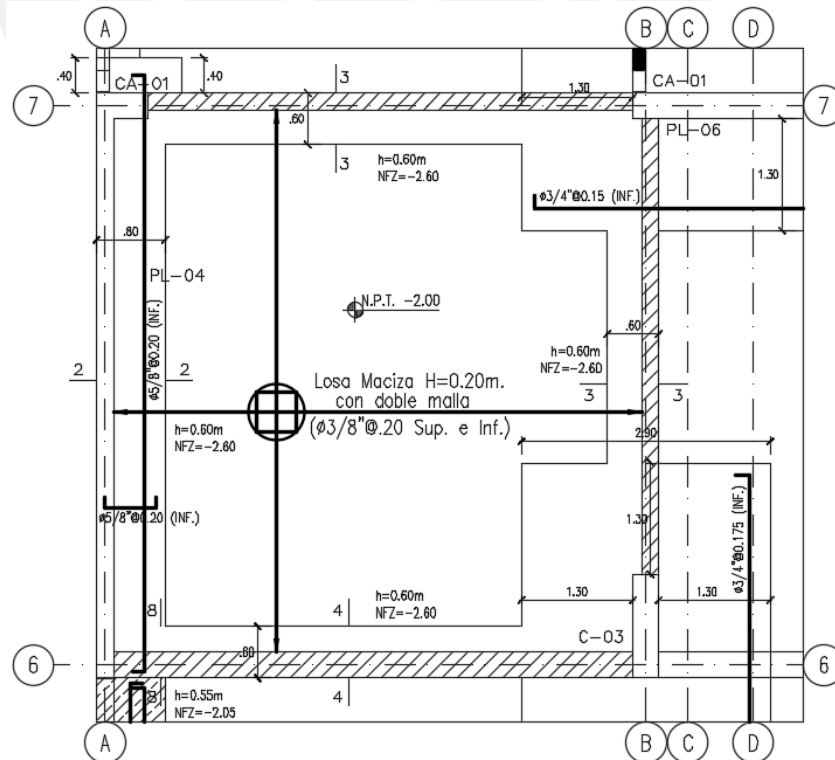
Disposición final de acero en la losa de piso de la cisterna.
